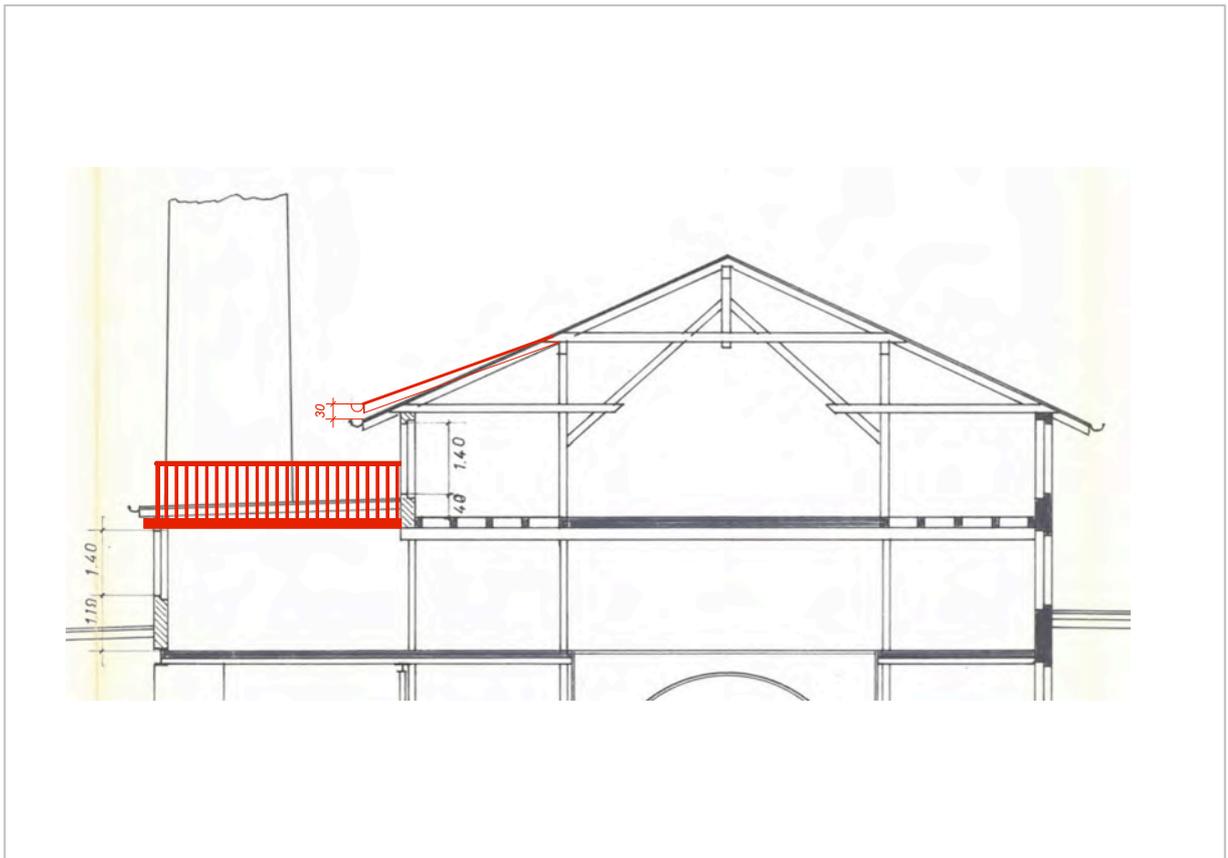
Schemaschnitt durch das Dachgeschoss des «Tonwerkgebäudes» mit einer Erhöhung der Traufe auf der Südostseite für eine Terrasse auf dem Vorbau
